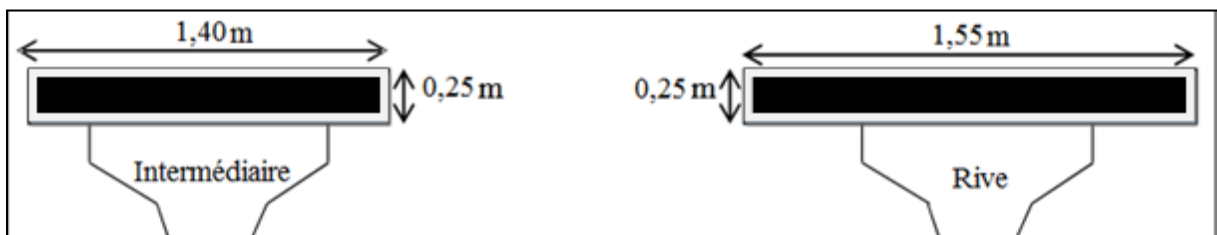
Partie de la dalle supportée par la poutre intermédiaire et la poutre de rive.
